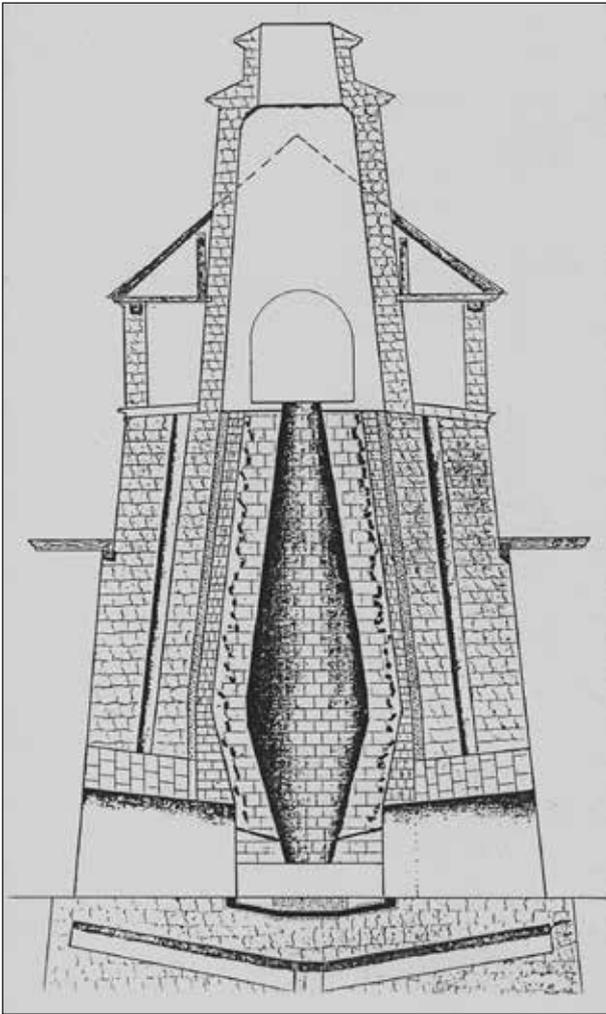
Hochofen (Längsschnitt) in Turrach, erbaut 1825/26 unter Leitung Peter Tunners d. Ä. Mit 1829 datierter Plan (Ausschnitt) im Technischen Museum Wien.
